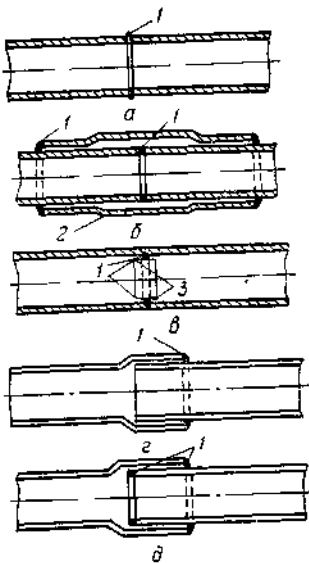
Типы сварных соединений стальных труб:
